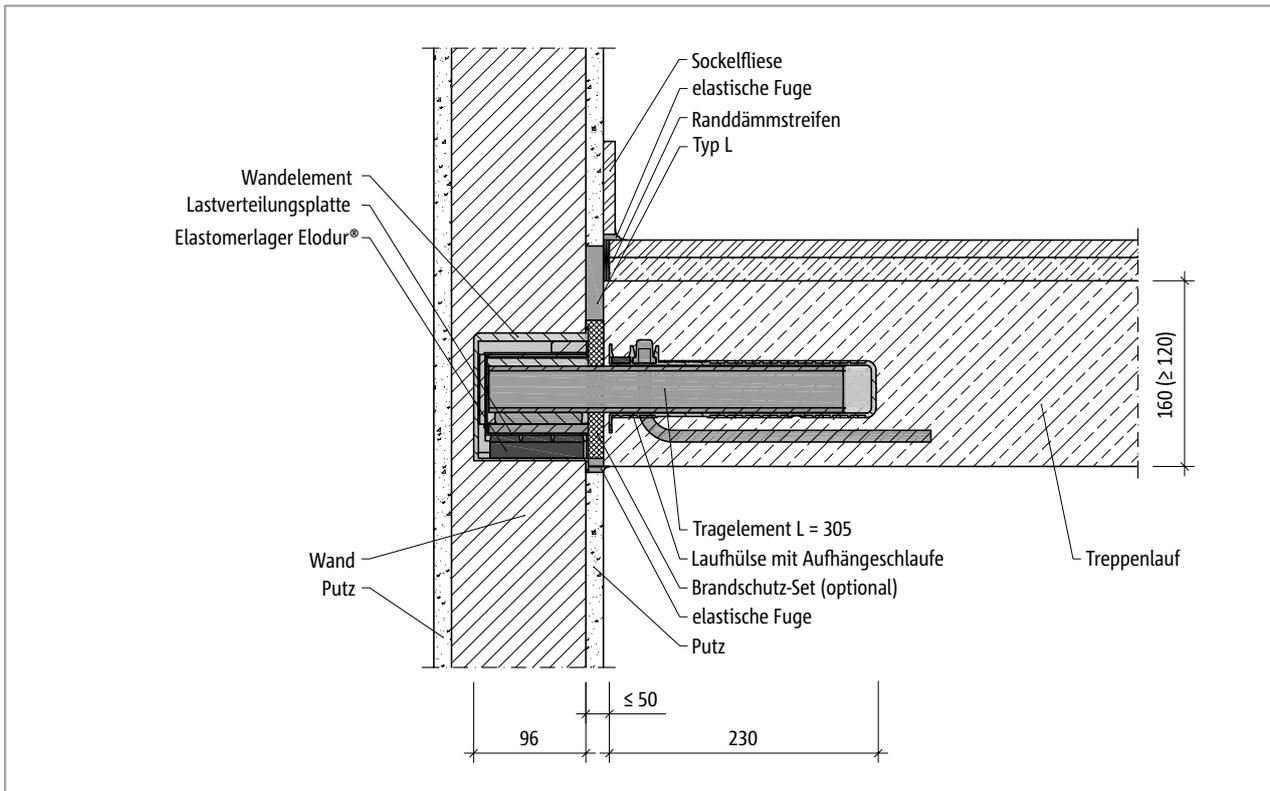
Schöck Tronsole® Typ Q-FV oder Q-A2: Einbauschnitt Wanddicke 11,5 cm
